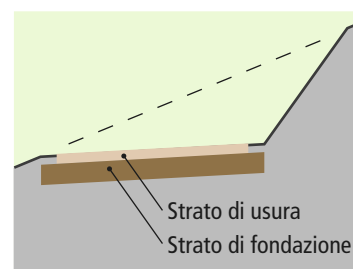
Profilo normale di un sentiero con strato di fondazione
